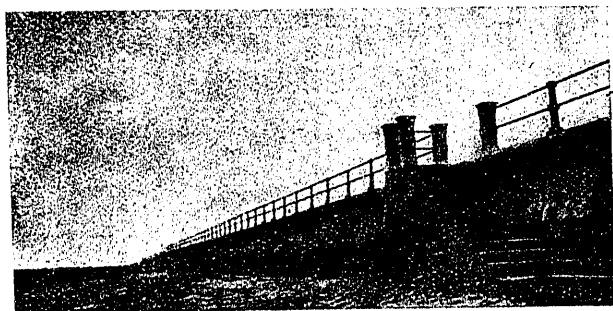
ª — Great Yarmouth. Muro de defensa de hormigón, con tablestacado de protección.
